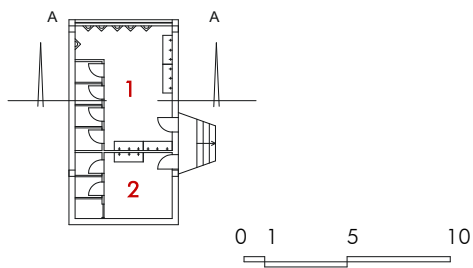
Planta do pavimento semi-enterrado: SENAI. Sanitários sob o hall de entrada da escola.
